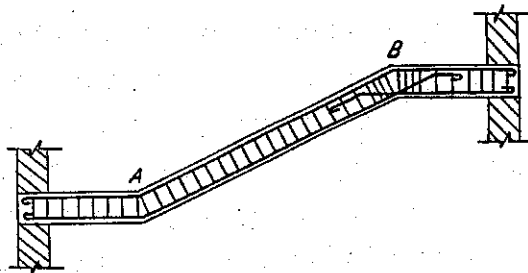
Bố trí cốt thép ở chỗ dầm ngang gãy khúc
